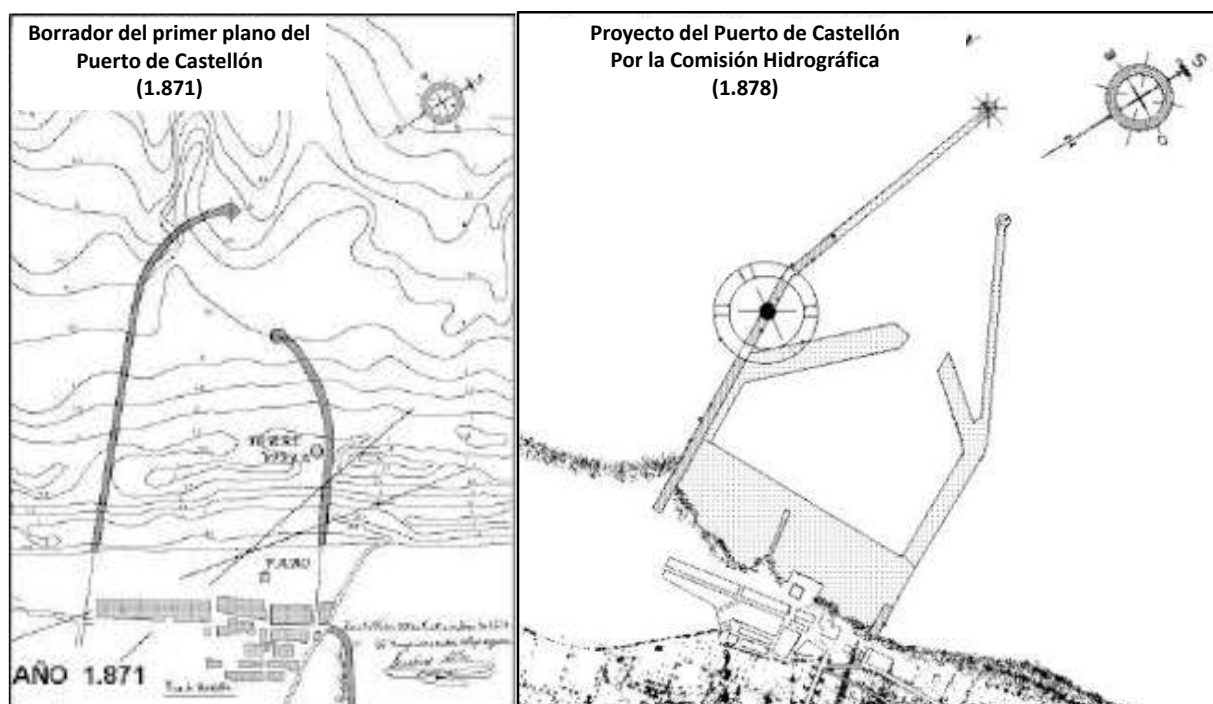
Plano del Puerto de Castellón (1871 – 1878)
